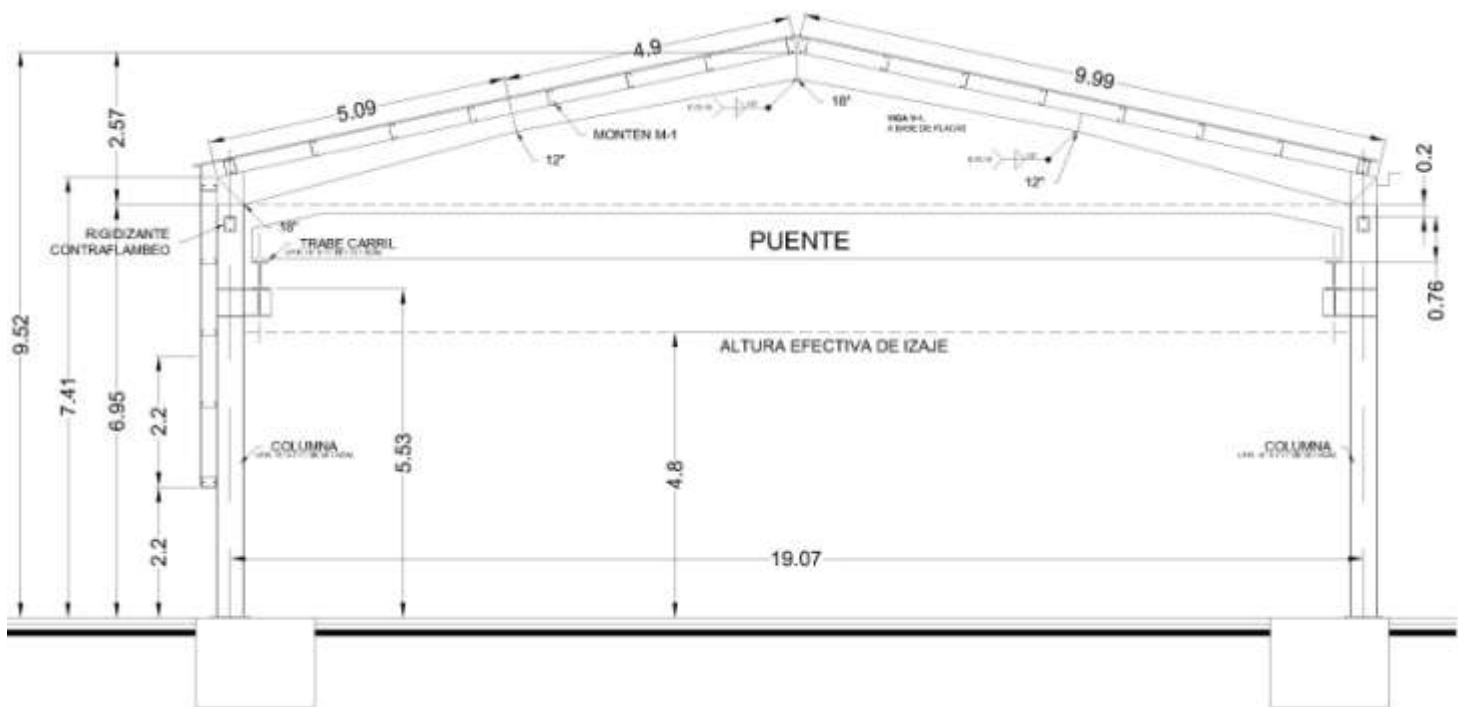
Sección transversal y detalles de nave de materia prima.
